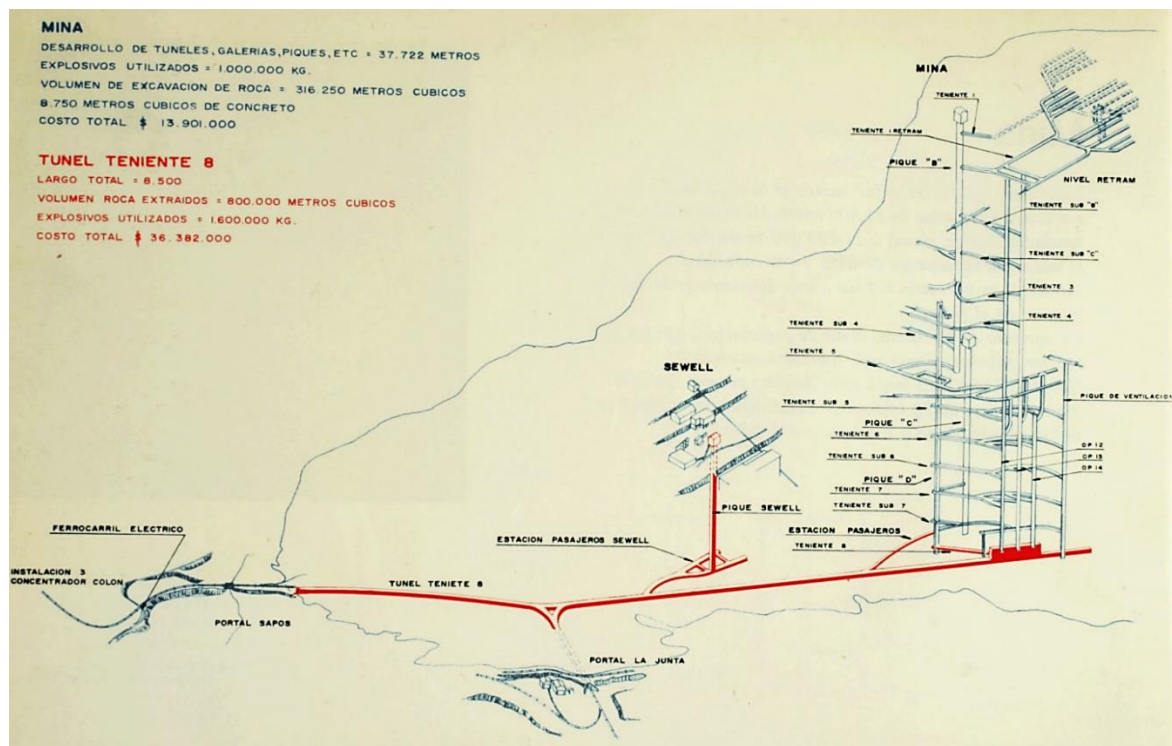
Disposición general mina y túnel teniente 8 que conecta Planta Sewell y Colon, 1970 (Fuente: Frei, 1970)
